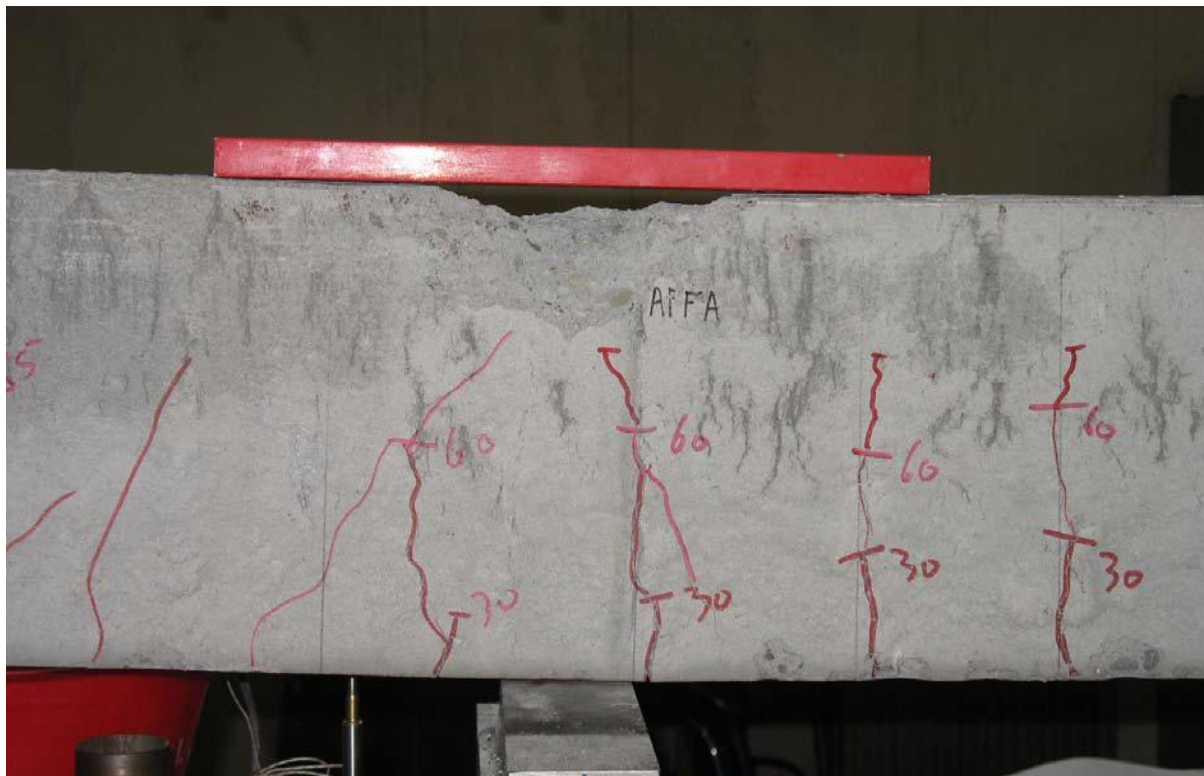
Trau T3- detaj i shkatërrimit të traut në zonën e shtypur të betonit
